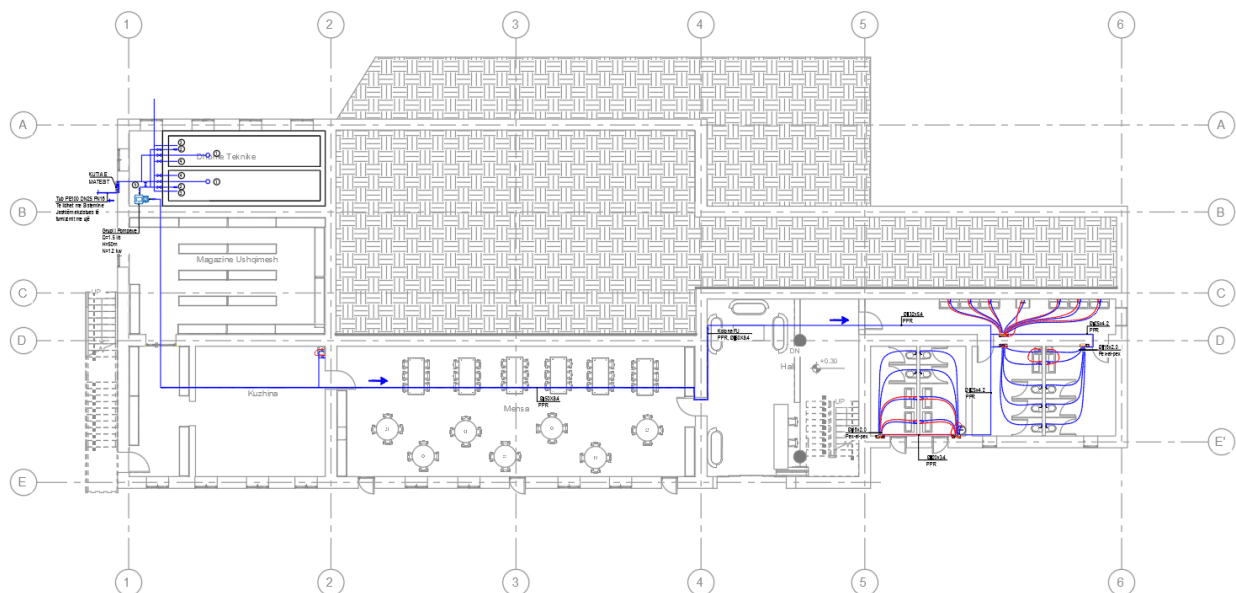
Planimetria e Njës Sanitare në katin përdhe
